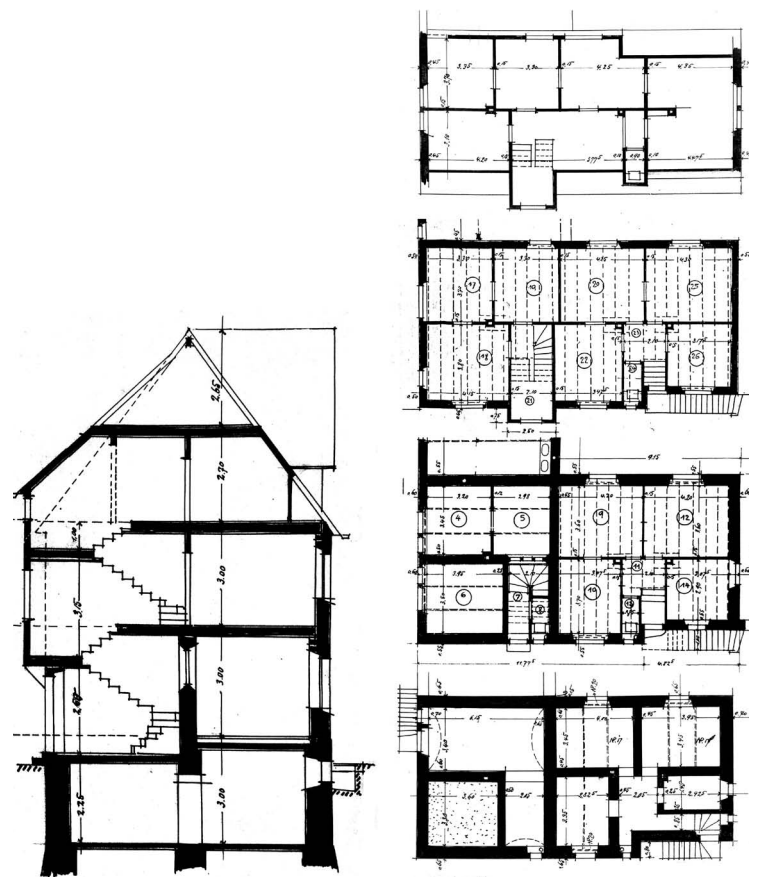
Bensheim, Arbeiterwohnhaus der Papierfabrik Euler, Grundrisse und Schnitt. 1902 (Montage aus Ausschnitten der Originalpläne)
